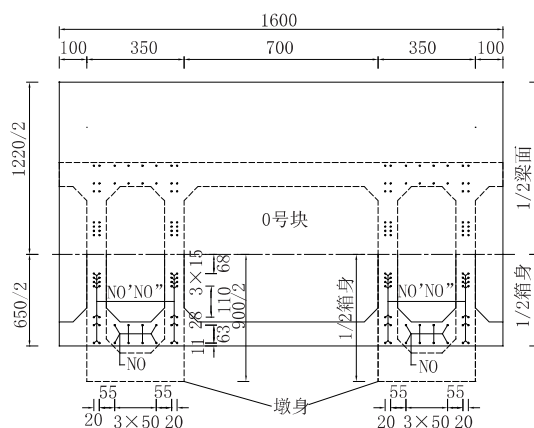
墩梁固结竖向预应力布置纵断面图(单位:cm)
